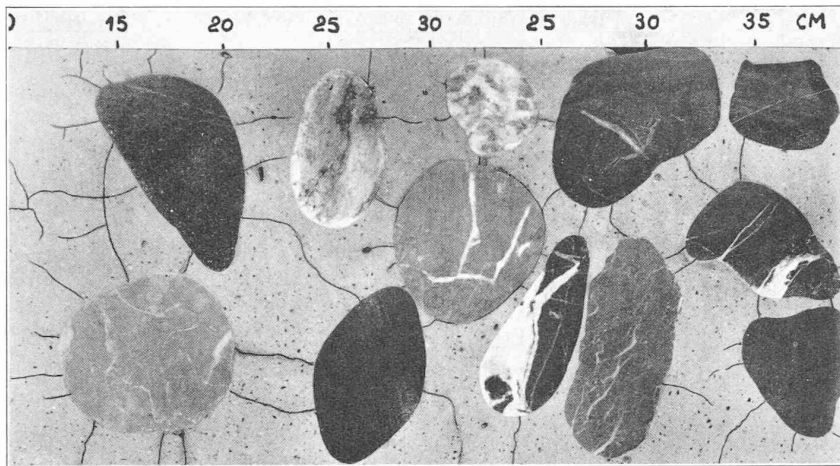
Coupe d'un prisme de béton sur laquelle on a fait ressortir la fissuration interne provoquée par les gros graviers lorsque le séchage du béton est trop rapide.
